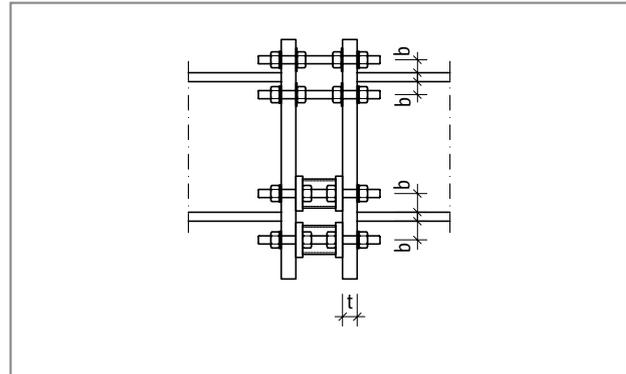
Plaque frontale T type S : tableau des entrées ; coupe
